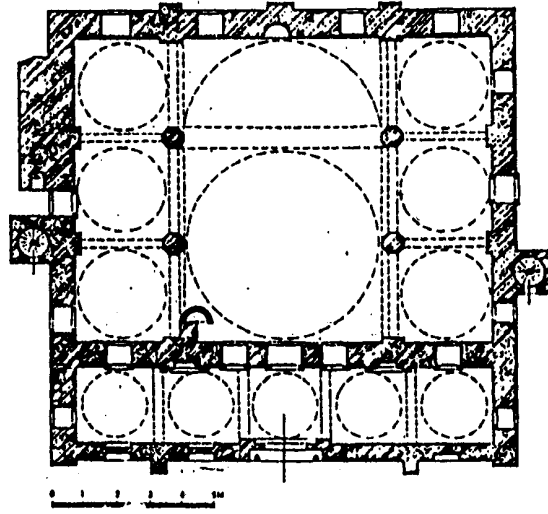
مسقط أفقي لجامع المرادية في مقيس (مانيسا)
